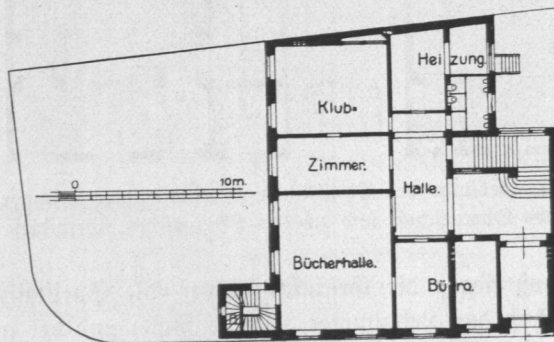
Volksheim Billhorner Mühlenweg, Erdgeschoß, Grundriß.
